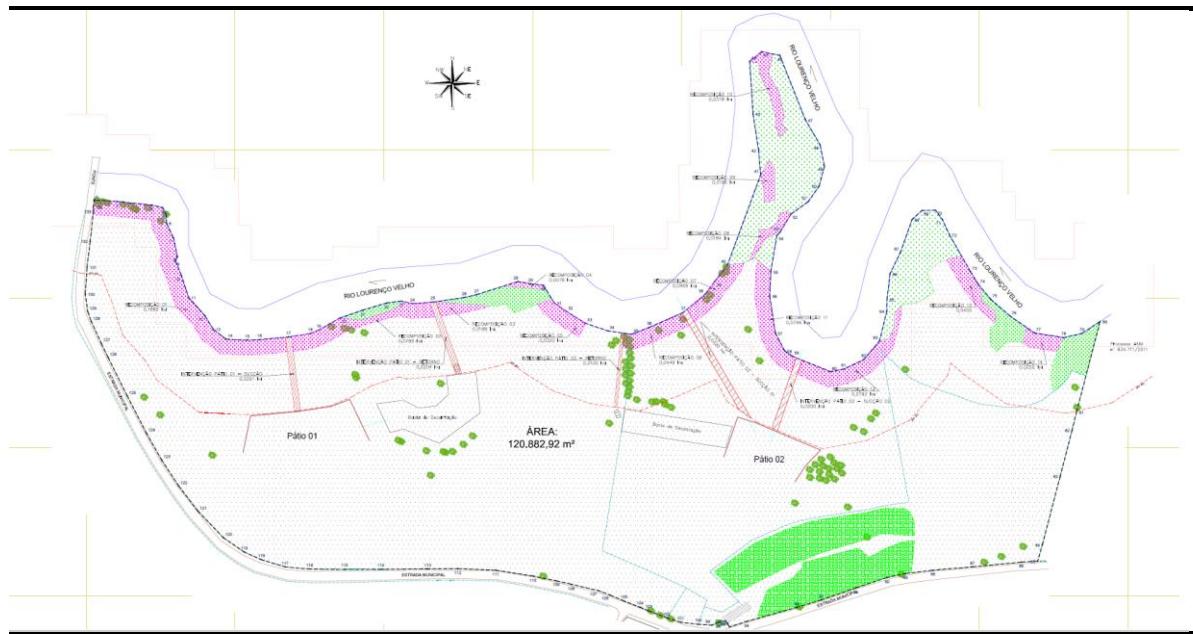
Planta topográfica mostrando os locais de intervenção (passagem das tubulações de succão e retorno).
